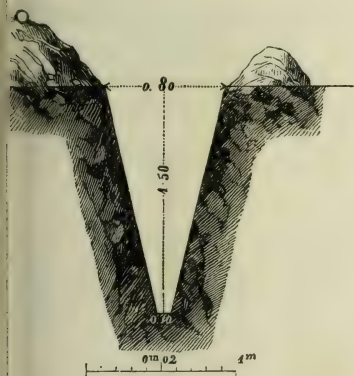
Tranchée profonde pour les terrains pierreux.
